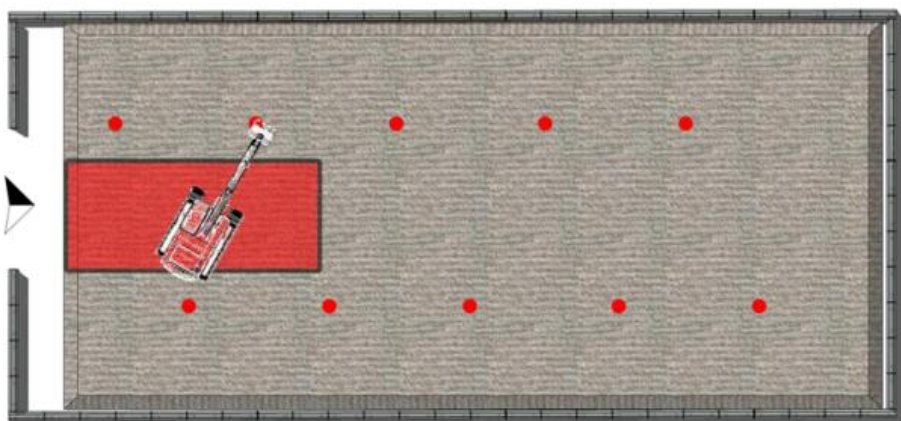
schema planimetrico con individuazione dei prelievi (in rosso) nella semi-piazzola (figura 9 dell'elaborato [a]).
